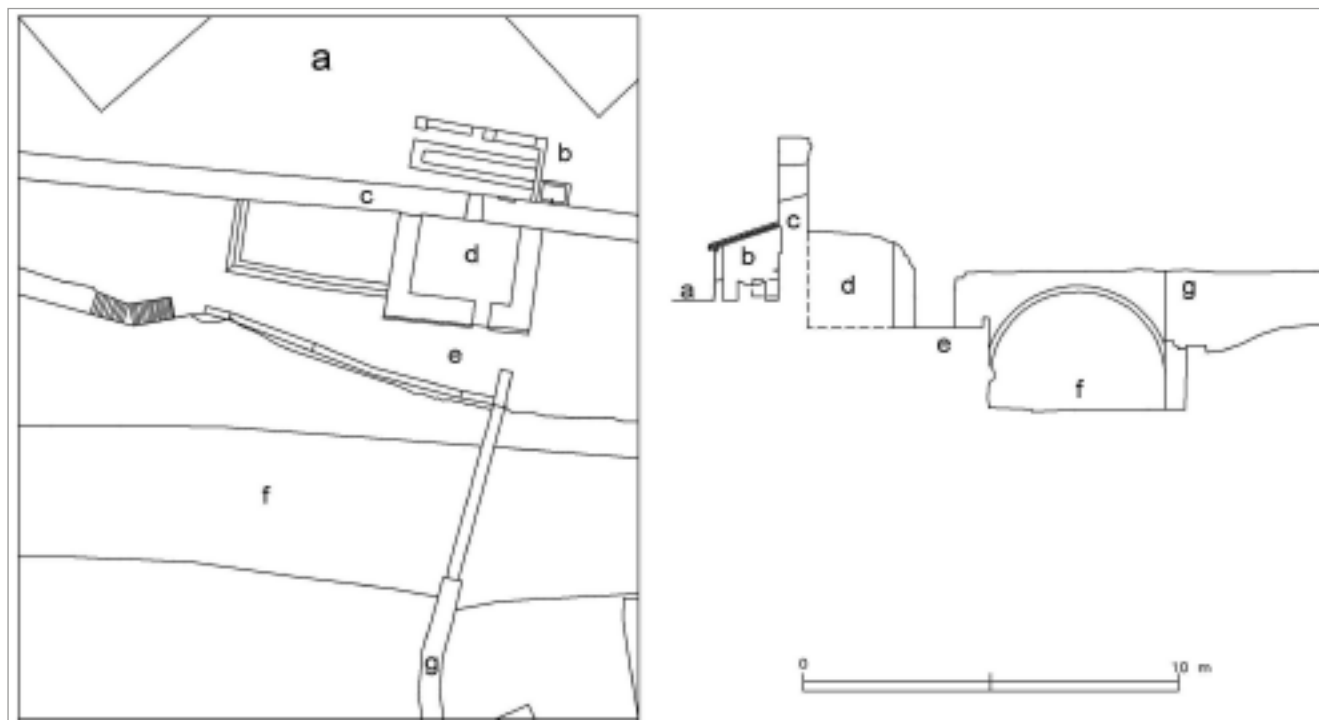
Planimetria e sezione prospettica dell'acquedotto (a: livello stradale; b: lavatoio e fontanile di Capone; c: muro di cinta; d: torre; e: barbacane; f: fossato; g: strutture dell'acquedotto (rilievo F. Bozzo).
